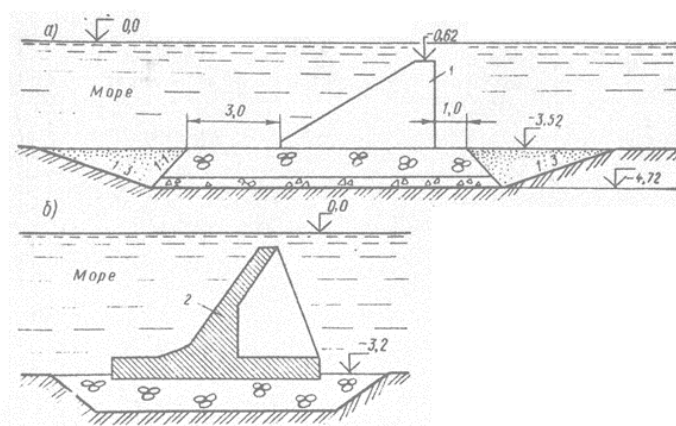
Конструкции подводных волноломов на мягких грунтах: а – конструкция из обыкновенных массивов; б – конструкция облегченного сооружения;
